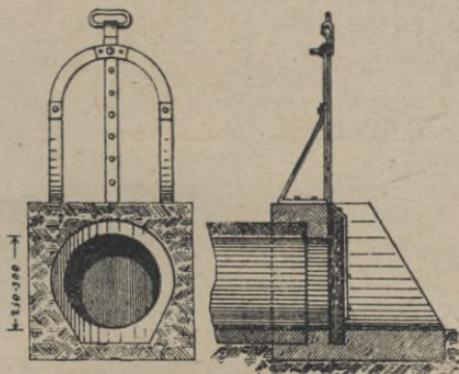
Schleusenstück mit festem Eisengerüst und Eichenholzschieber für runde Rohre.
